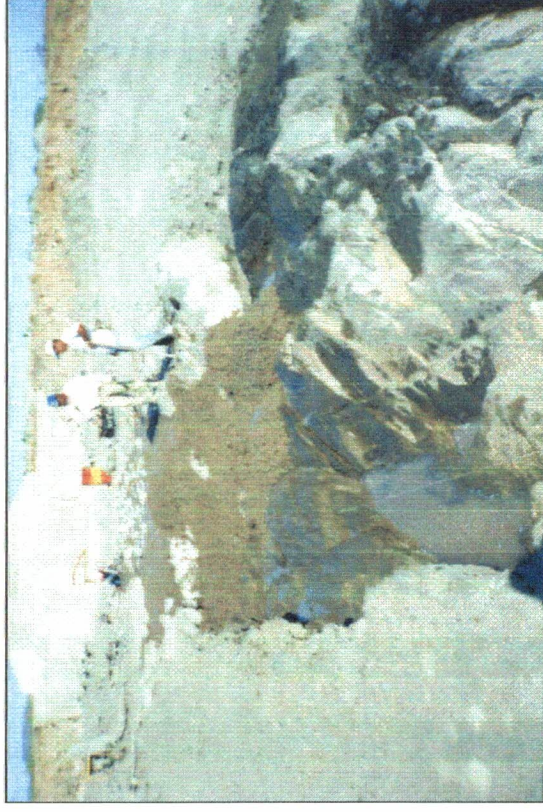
Concretagem das fundações do bloco do perfil "Creager".
